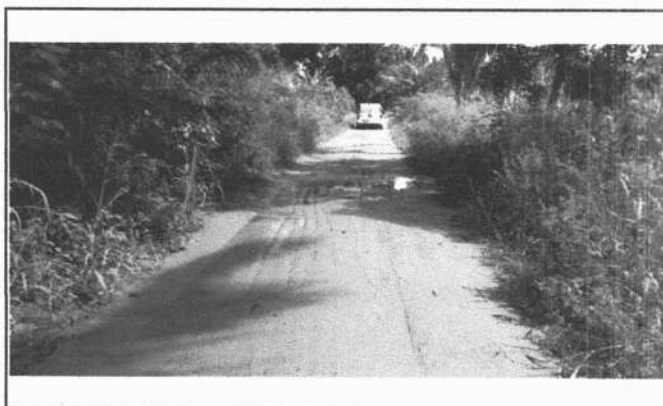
LOCALIZAÇÃO DO BUEIRO 02
